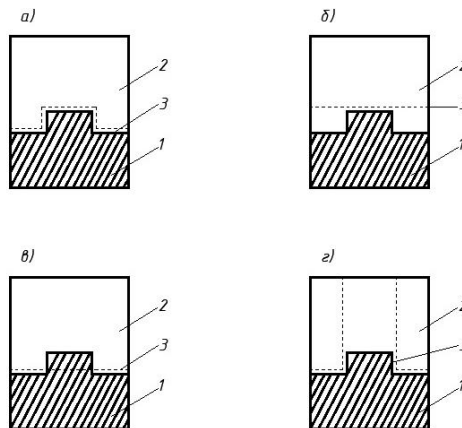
Варіанти зсуву для балок з повздовжньою шпонкою (поперечні перерізи)
